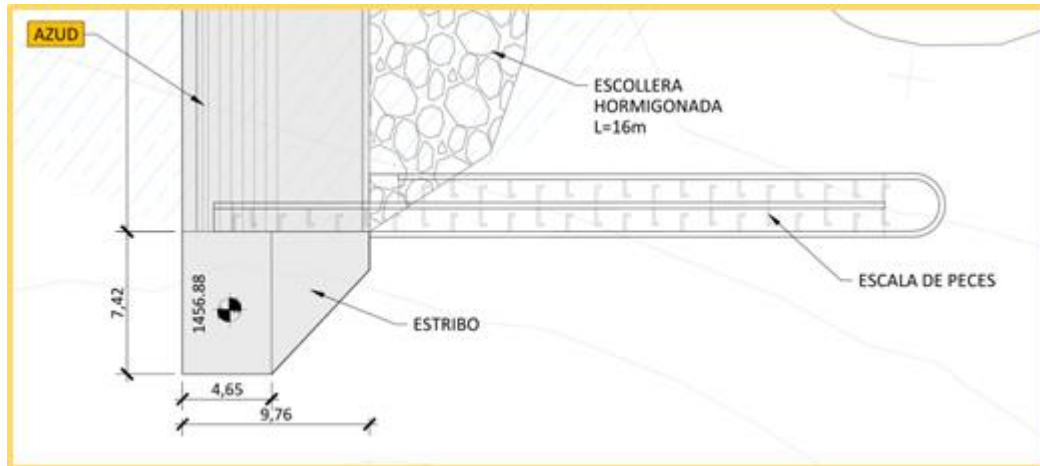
Planta de Escalera de Peces adyacente al Azud
